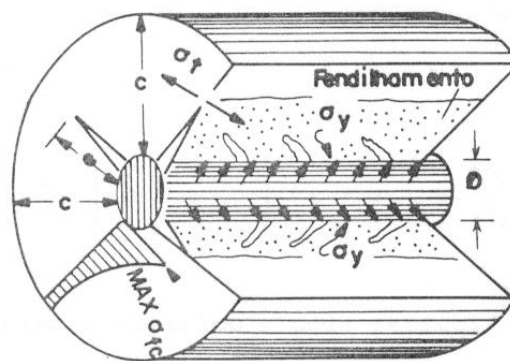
Diagrama esquemático da deformação do concreto ao redor da barra de aço após a formação das fissuras internas causadas por tensões principais de tração (GOTO, 1971).
